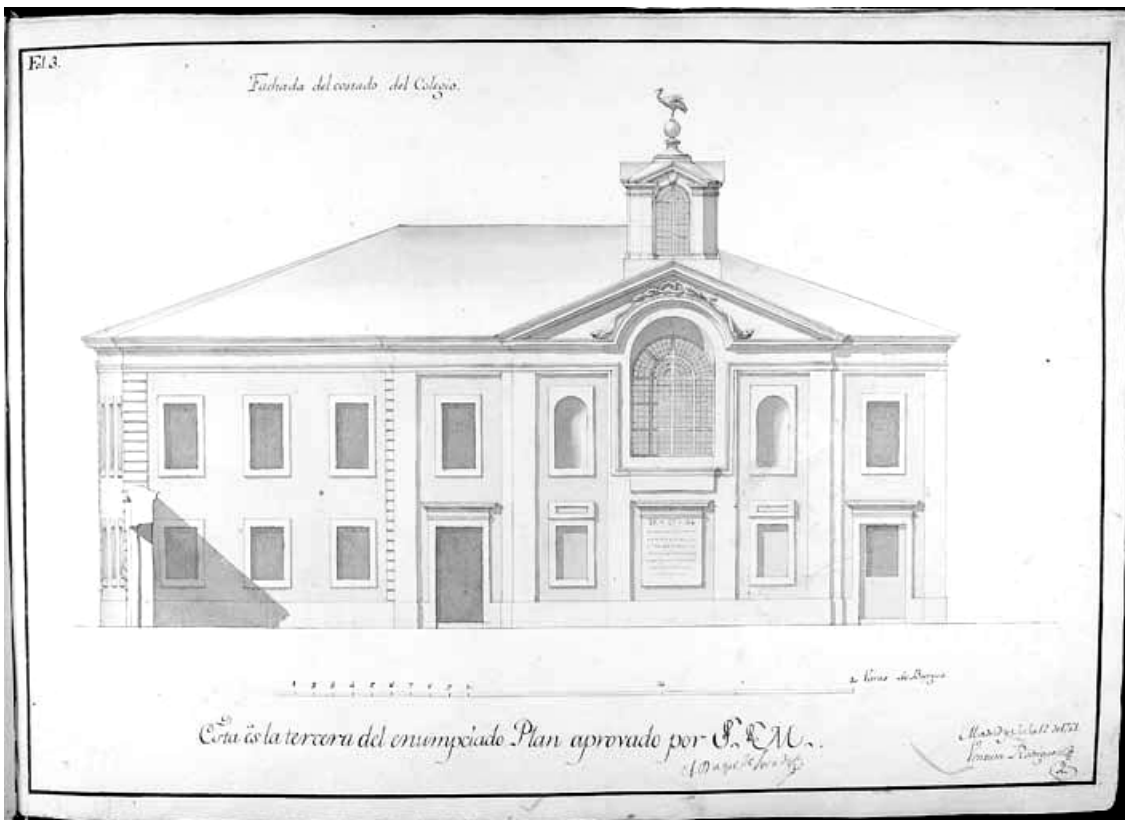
Real Colegio de Cirugía de Barcelona, elevación fachada suroeste. © Archivo USC.
